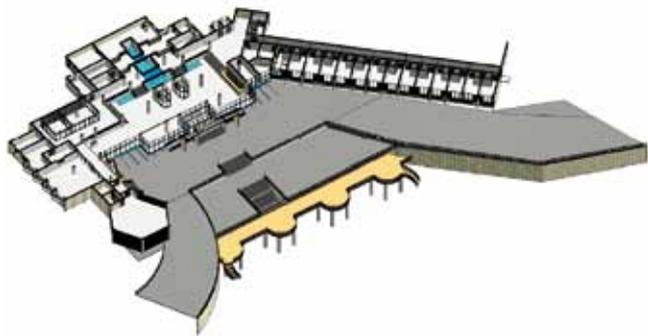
湖北省林业厅培训基地琵琶湖接待中心平面图
